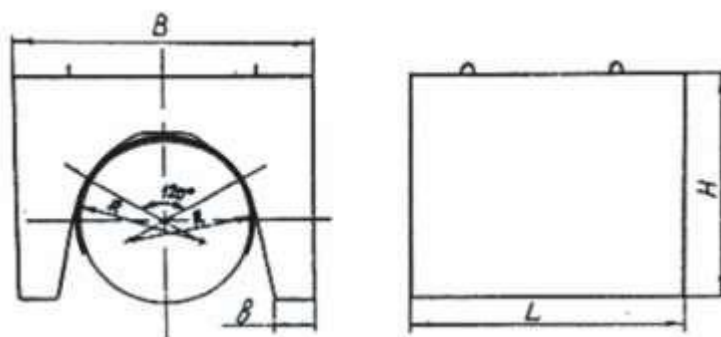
Железобетонный утяжелитель типа 1-УБКм.
